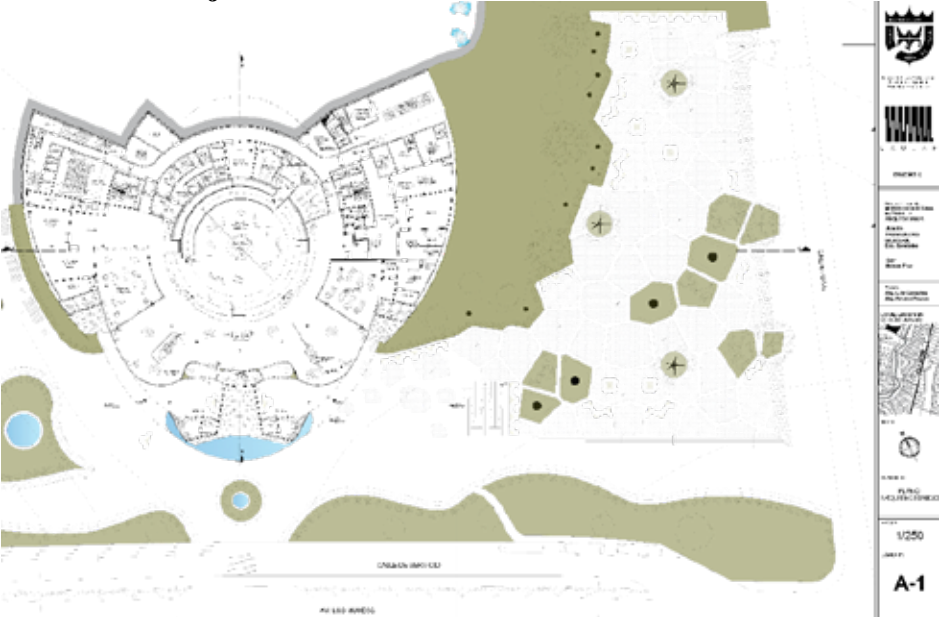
Planta Baja Nivel +0.00. Fuente: Autor (2021)
